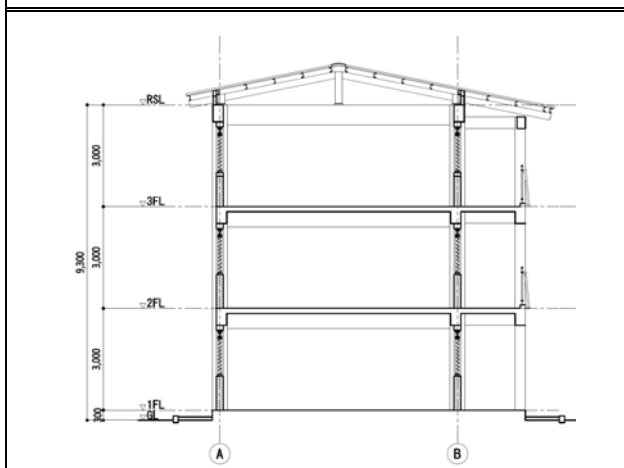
Construction 3 étages 3 salles de classe avec passage latéral (Type B)
